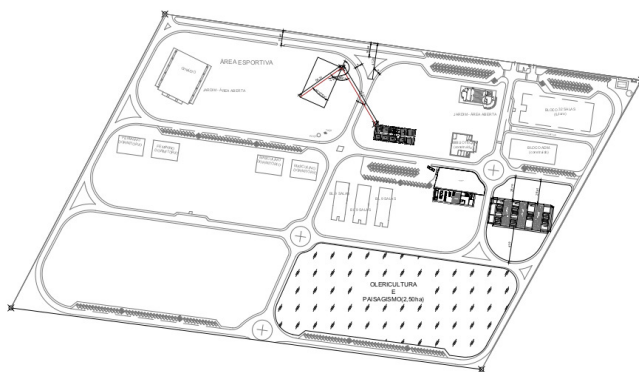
Planta baixa do planejamento do *campus* Colinas do Tocantins - IFTO
